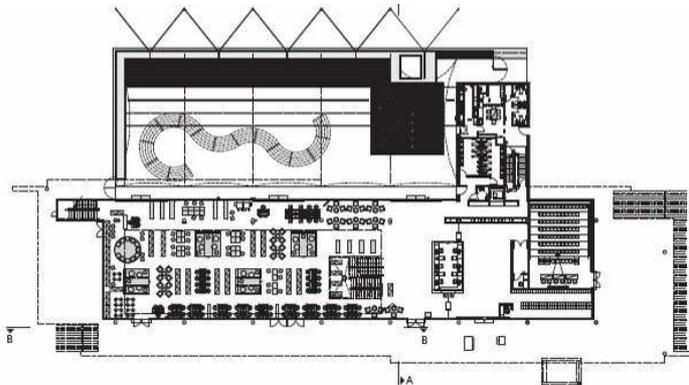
Planta baixa pavimento térreo (DUCCI, LARSEN, MARTINS, 2010)
